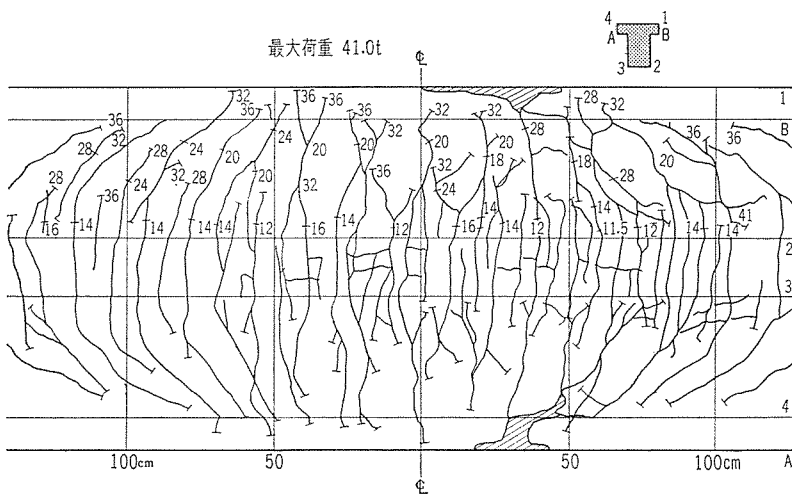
軽量コンクリート (A'-1) ひびわれ図
